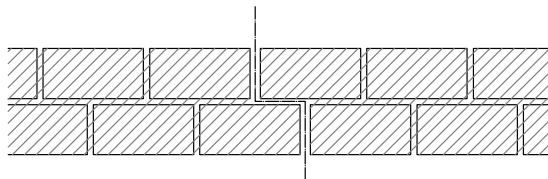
Junta de dilatación con solape. Esquema en planta
